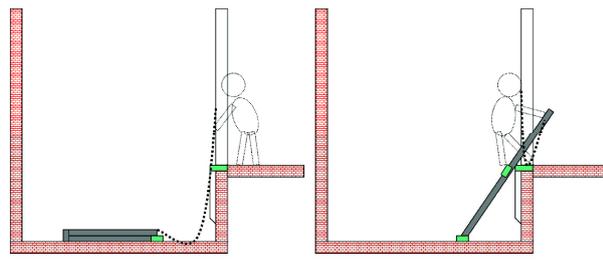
Typ 4 – Zusammenklappbare Schachtgrubenleiter
